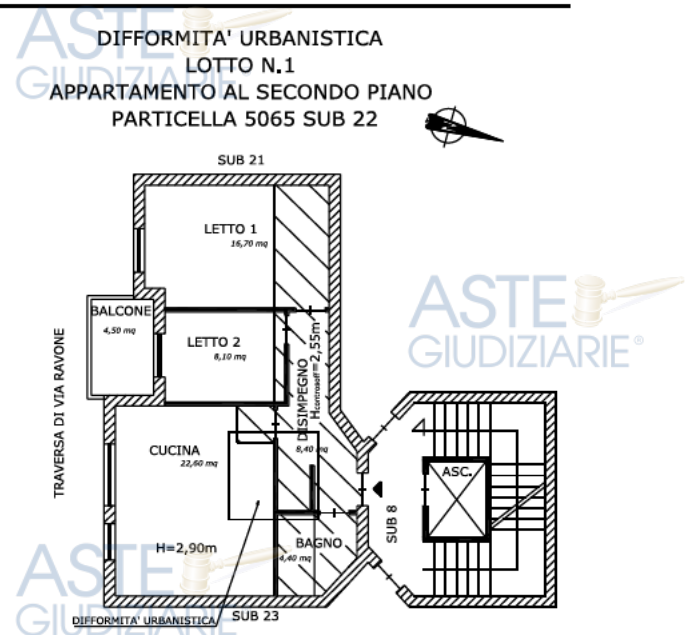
Planimetria delle difformità urbanistiche del LOTTO N.1
